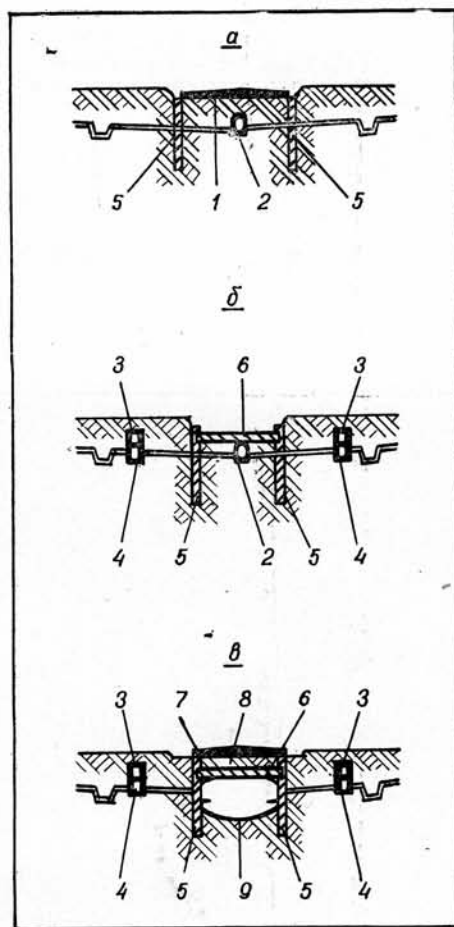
Последовательность сооружения тоннеля методом «выемка под перекрытием»:
